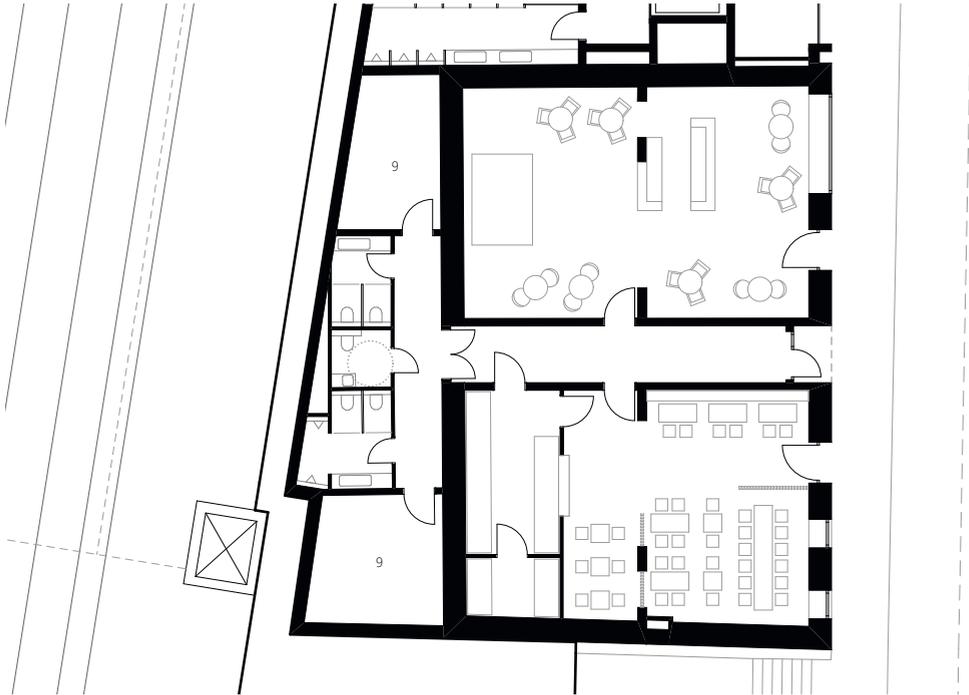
; Ausschnitt, vermietbares Restaurant & Bar, Untergeschoß, 1:250
